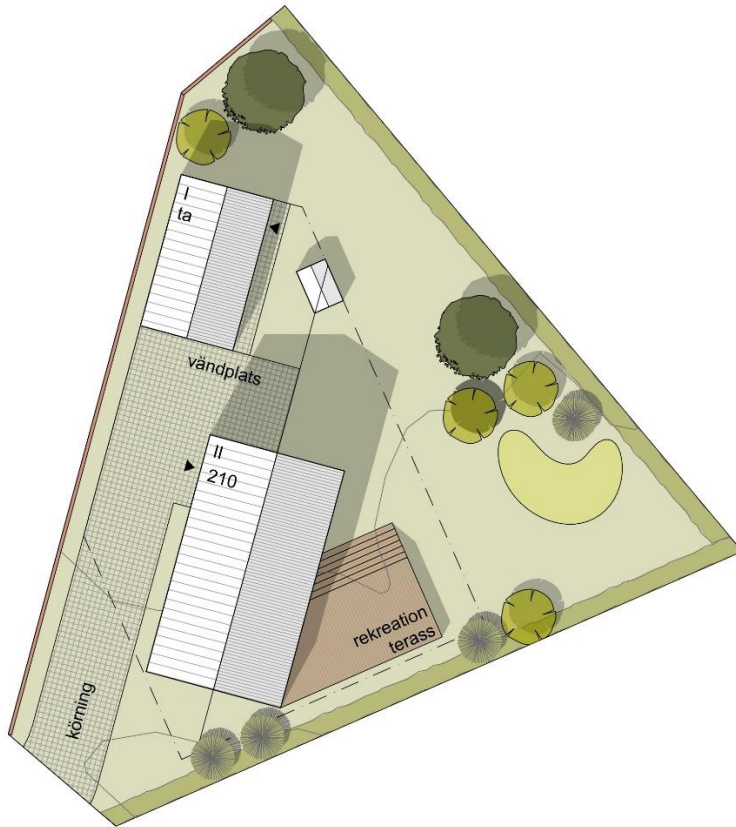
Idébild om placeringen av byggnader och konstruktioner
